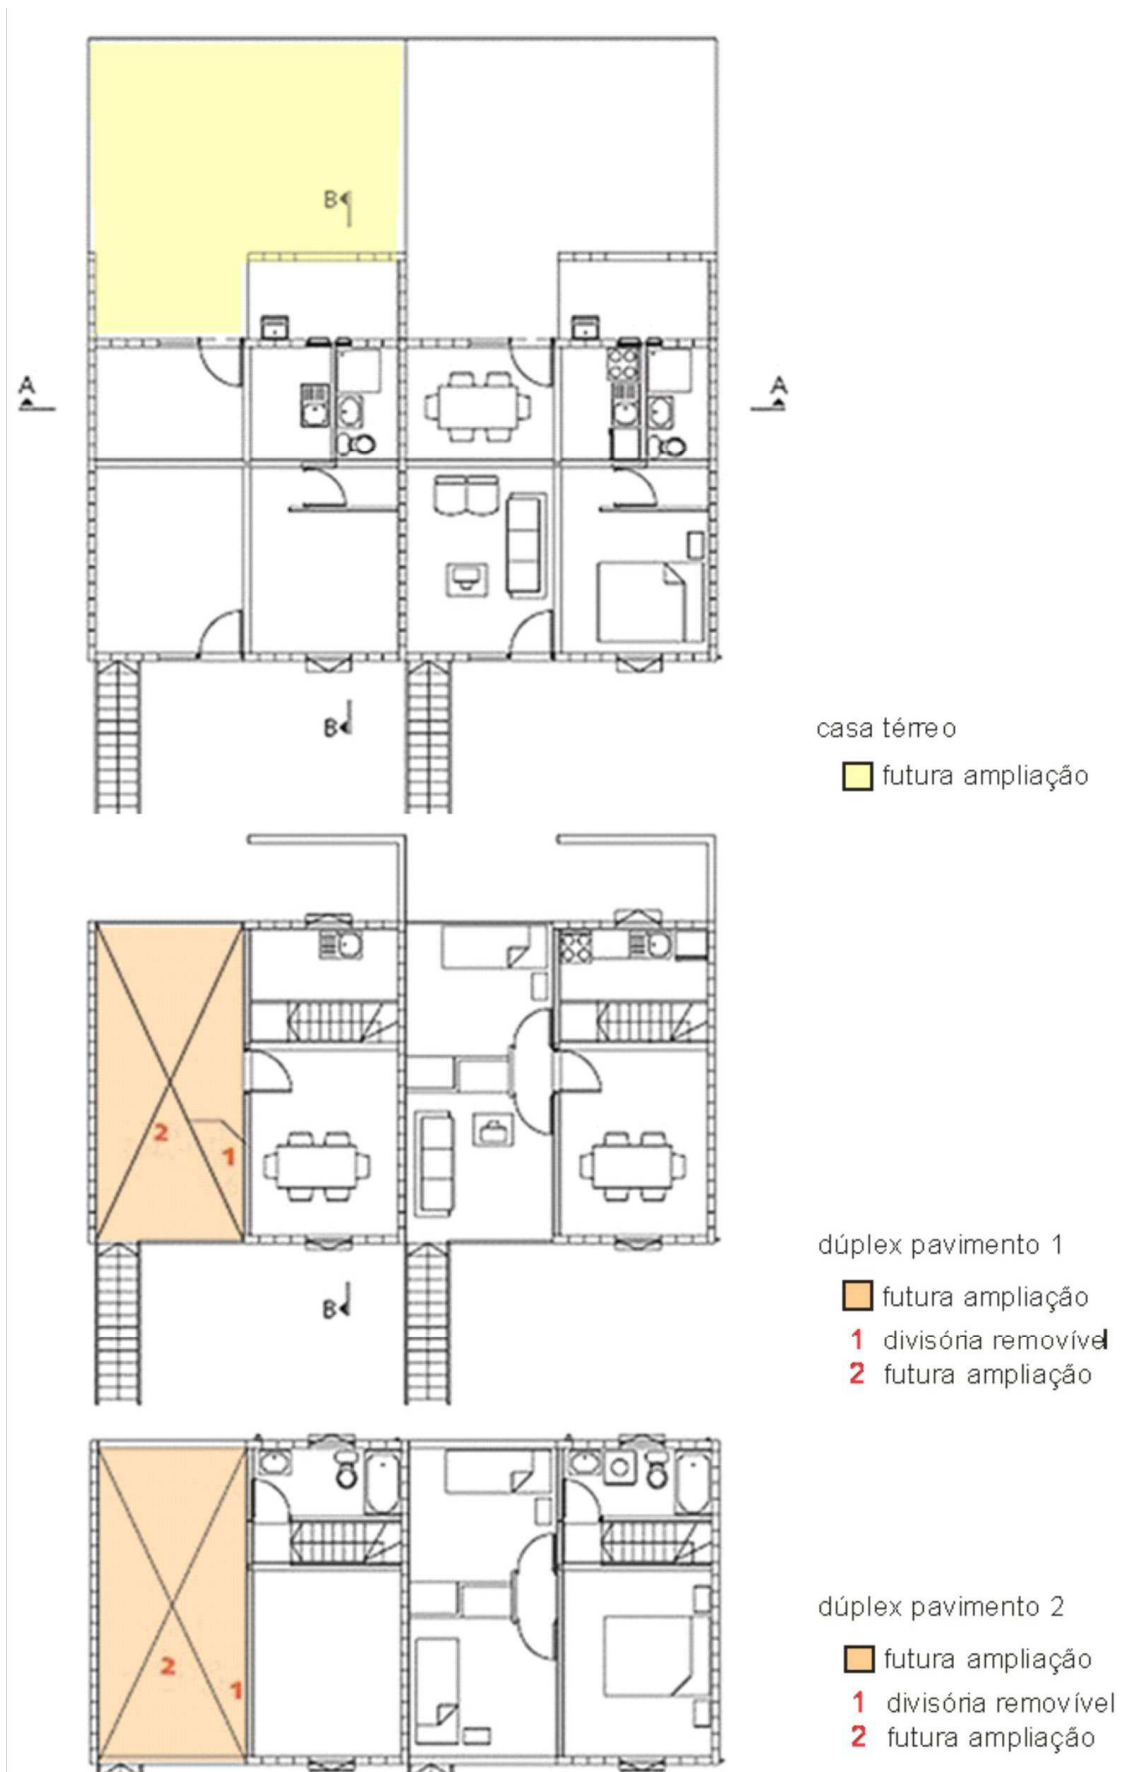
CONJUNTO LO ESPEJO: PLANTA BAIXA.
